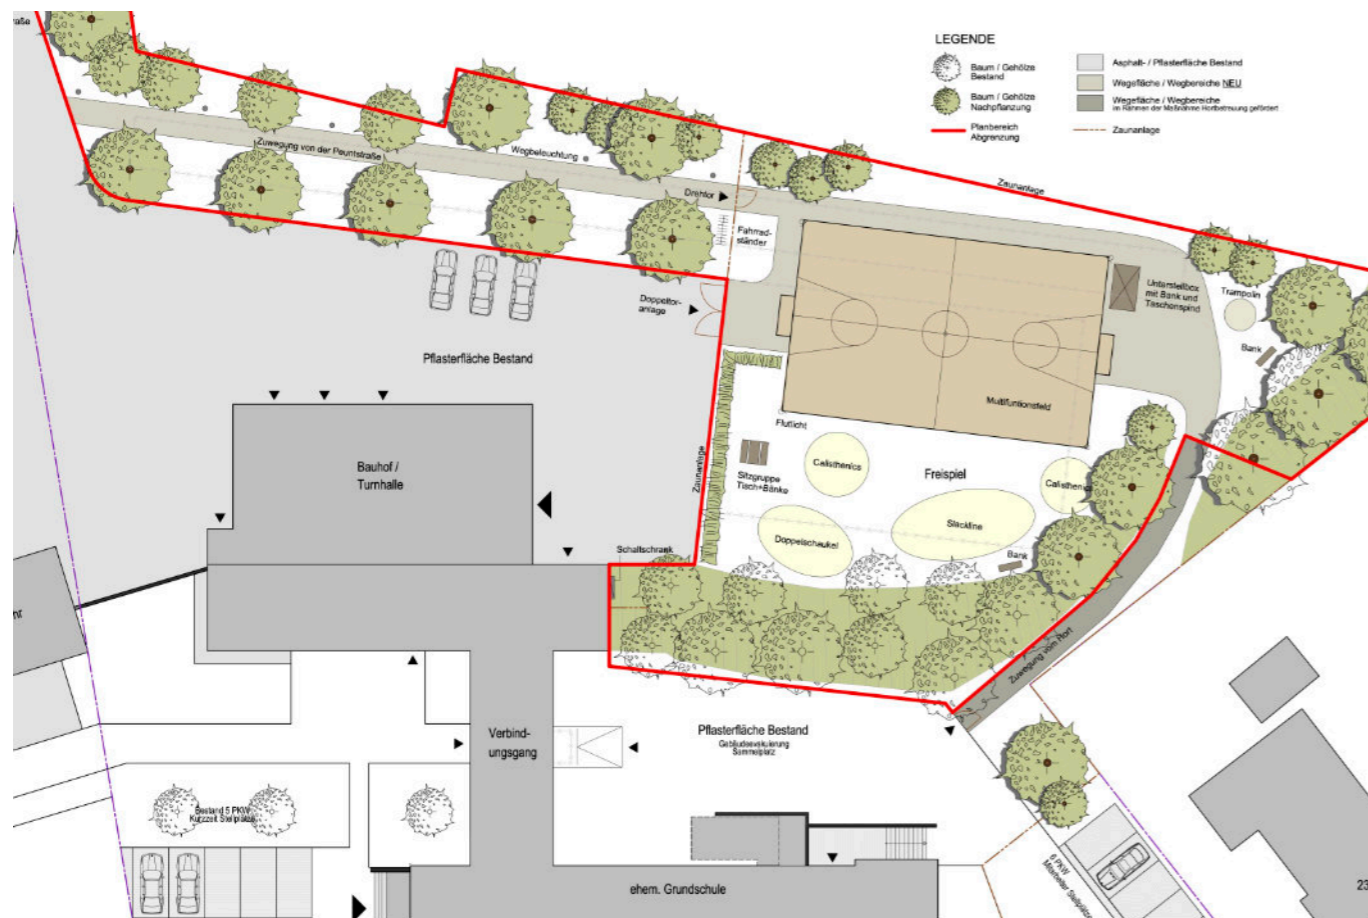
Planung Sportanlage Peuntstraße, o.Maßstab (Quelle: Markt Sparneck/Architekturbüro Hoffmann, 2024).
